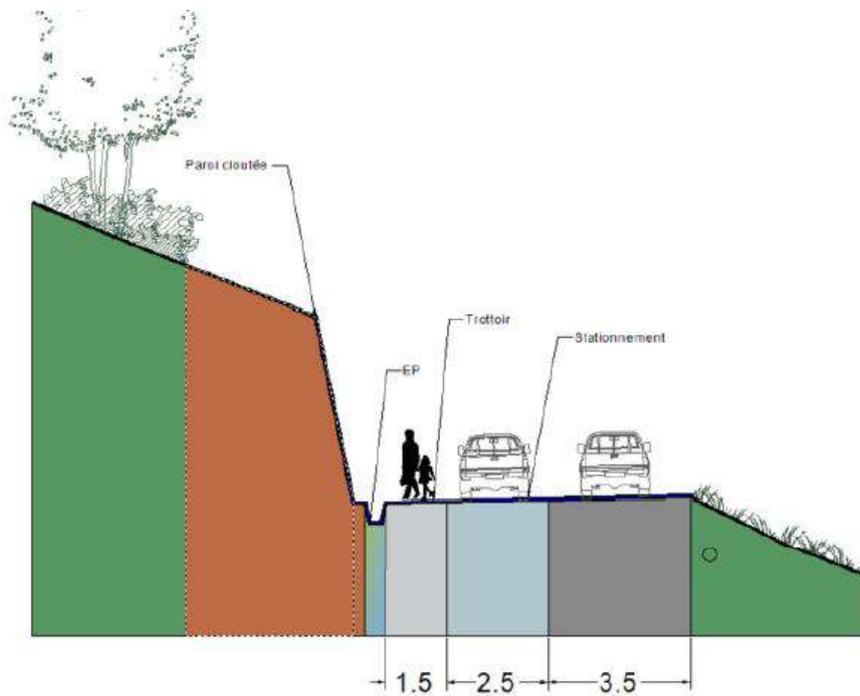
Profil en travers rue des coteaux sur l'intercepteur
